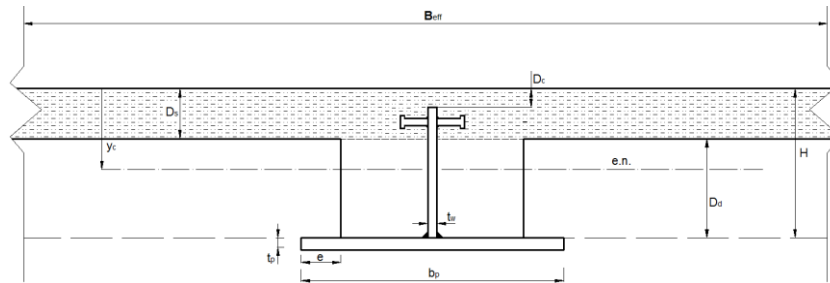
Secção de uma viga mista do tipo *Inverted T Beam*.
